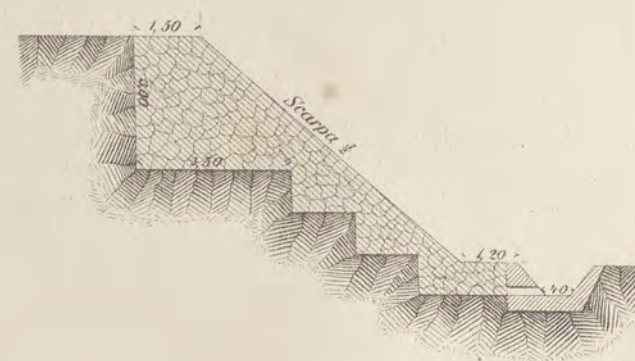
<sup>a</sup> Profilo longitudinale secondo l'asse della strada.
